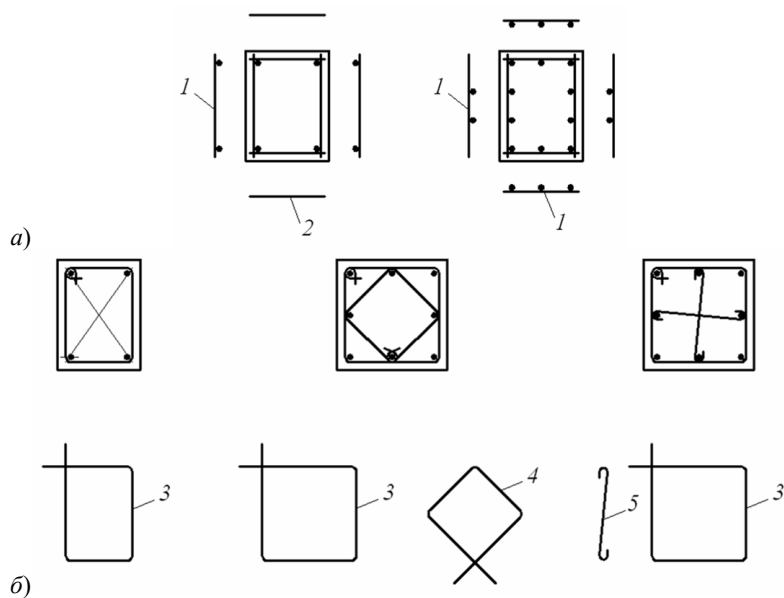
Армирование сжатых элементов со случайными эксцентриситетами: а – сварными каркасами; б – вязаными каркасами; 1 – сварные каркасы; 2 – соединительные стержни; 3 – хомуты; 4 – дополнительные хомуты; 5 – шпильки
